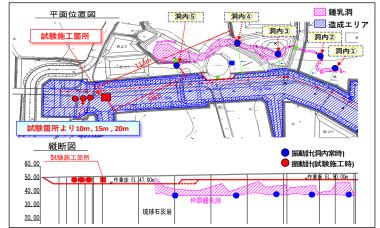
洞内振動測定箇所並びに試験施工時の測定位置図
